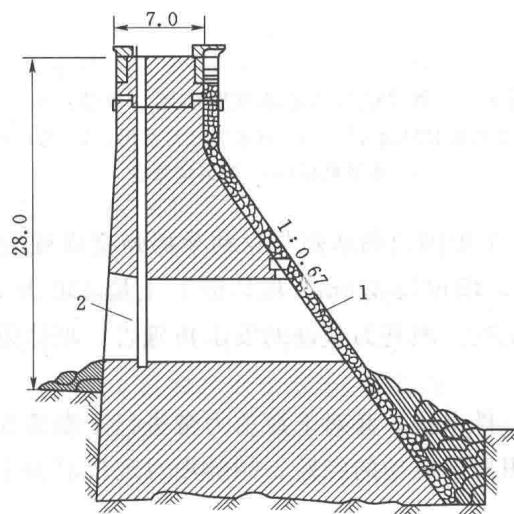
阿斯旺坝泄水底孔坝段坝体断面图 (单位: m)
